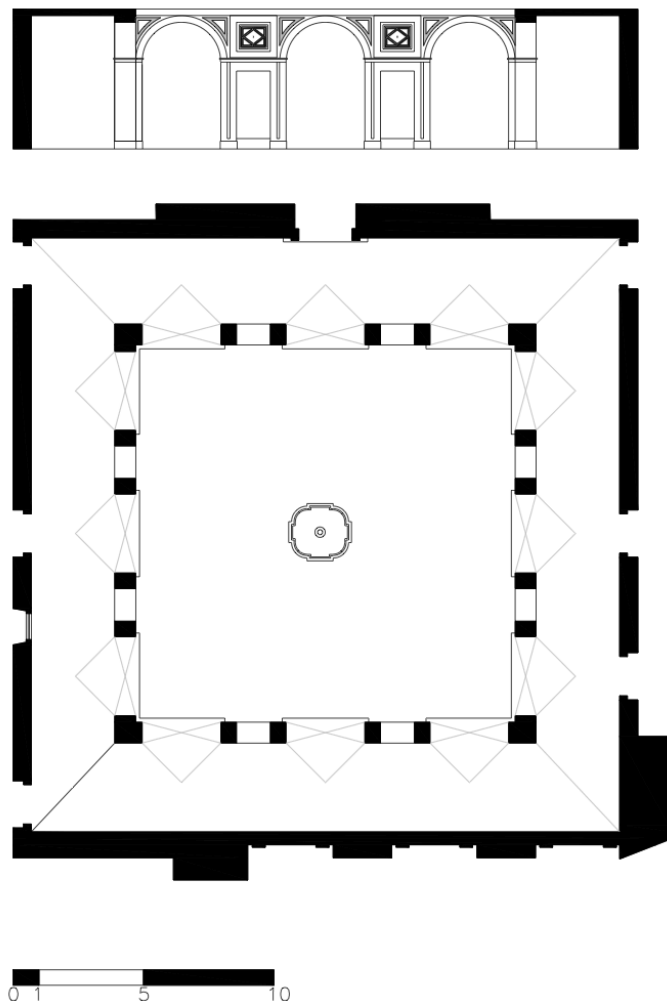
| Alçado e planta do piso térreo do claustro do Convento de São Domingos de Benfica – desenhos do autor
